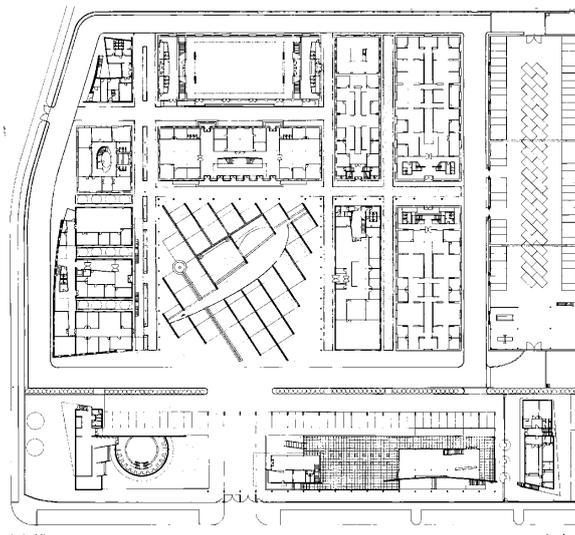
Planta general. Estado actual. (Fuente: SV60 Cordón & Liñán Arquitectos)
